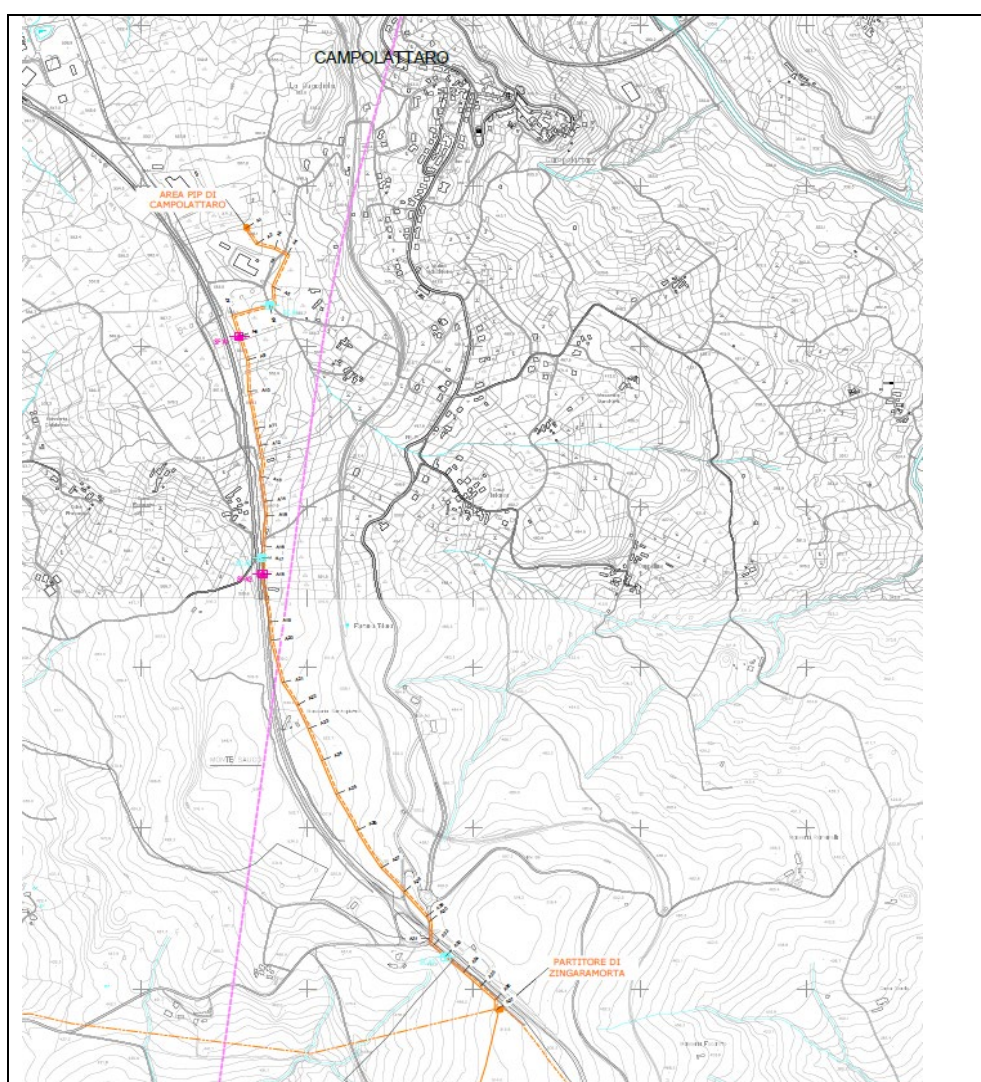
Planimetria Nuovo serbatoio Area PIP
